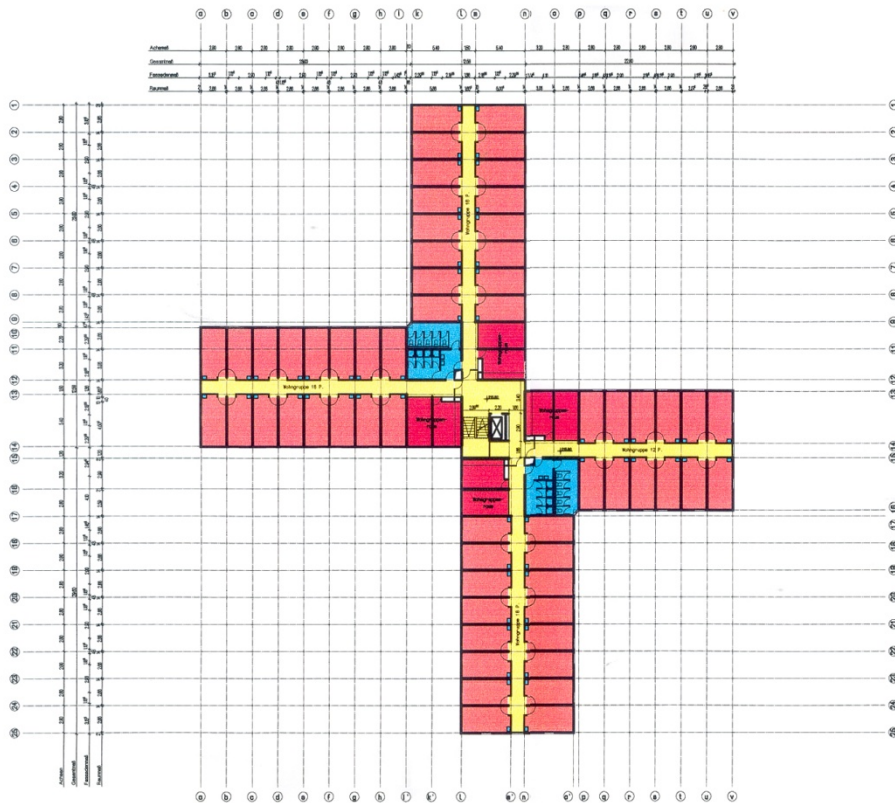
Grundriss eines der beiden Gebäude vor der Sanierung. Ein Flur mit 16 Wohneinheiten teilte sich eine Küche (rot markiert), die Sanitärräume (blaue Markierung) waren für 32 Benutzer vorgesehen, in einzelnen Zimmern gab es jeweils nur ein Handwaschbecken.
